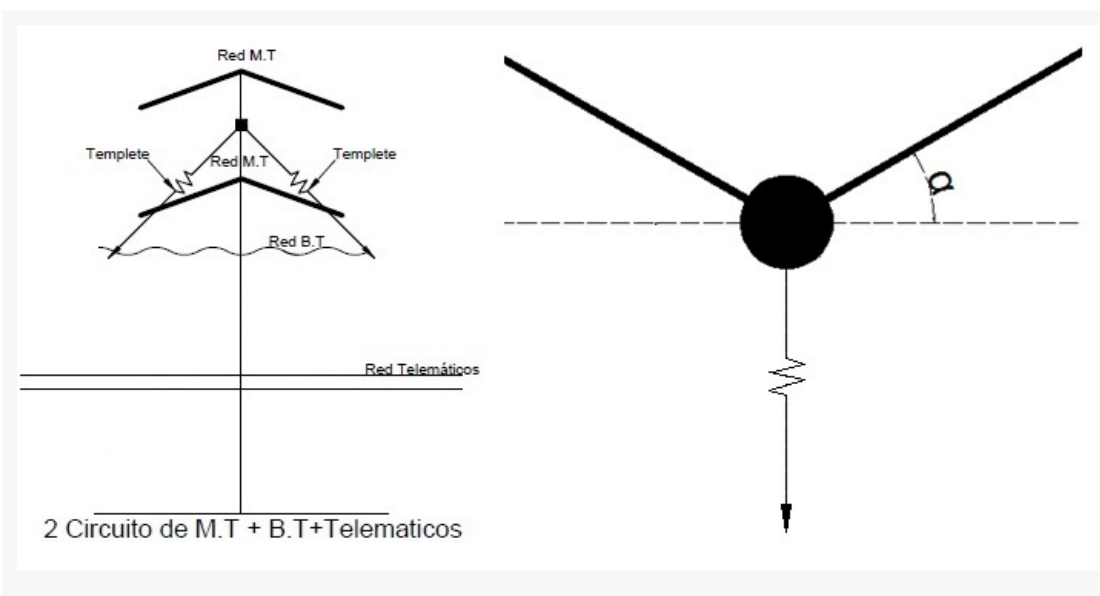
Disposición templete estructura retención en ángulo con postes de 3000kgf, con red aérea de M.T cuádruplex + B.T + Telemáticos, Vista frontal y planta.
